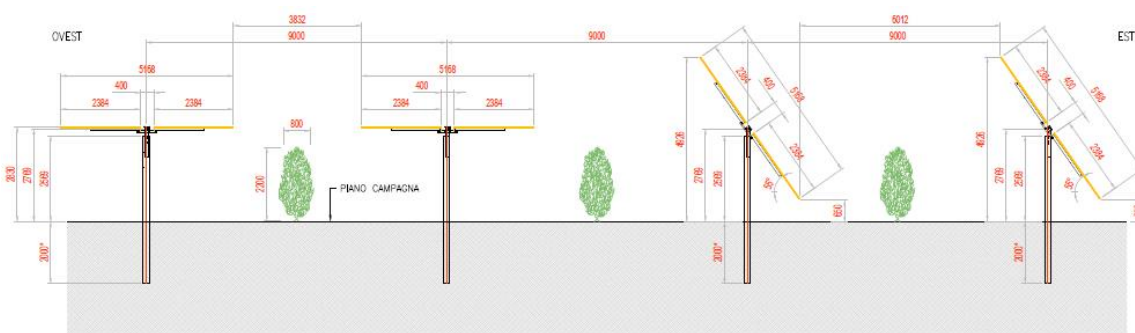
Tipologico – Sezione dell’impianto Olivicolo.
